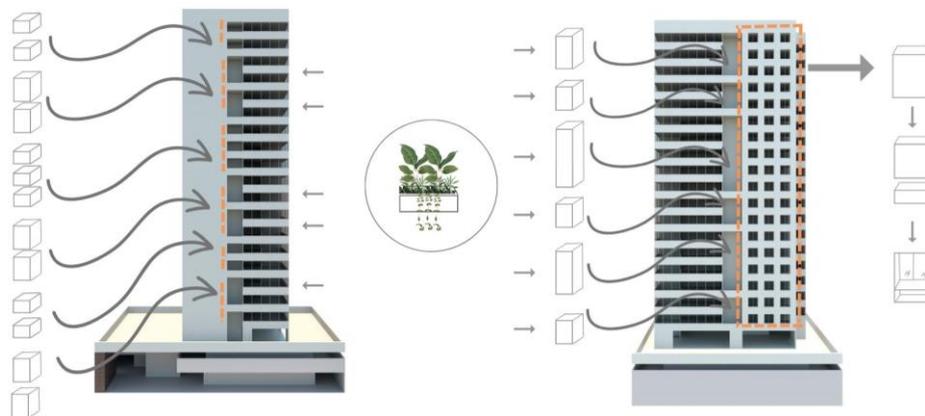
Edifício Príncipe de viver - Subtração da fachada principal (esquerda) e subtrações das fachadas-janelas (direita). Fonte: Adrião, 2023.
